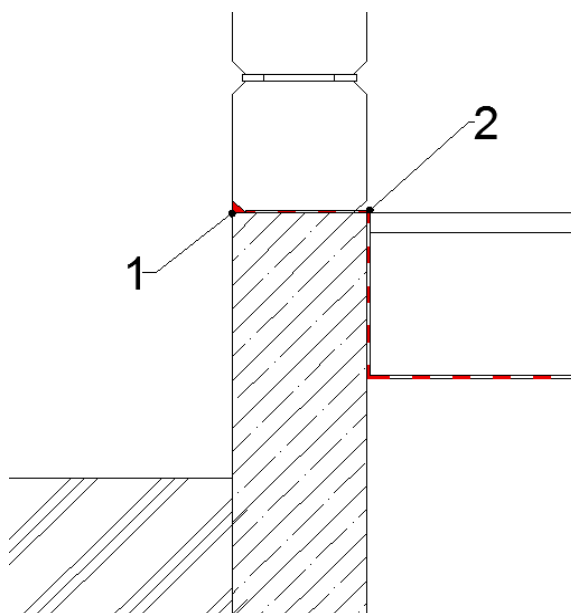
Schéma podepření stropní konstrukce a krovu (vlastní zdroj)
